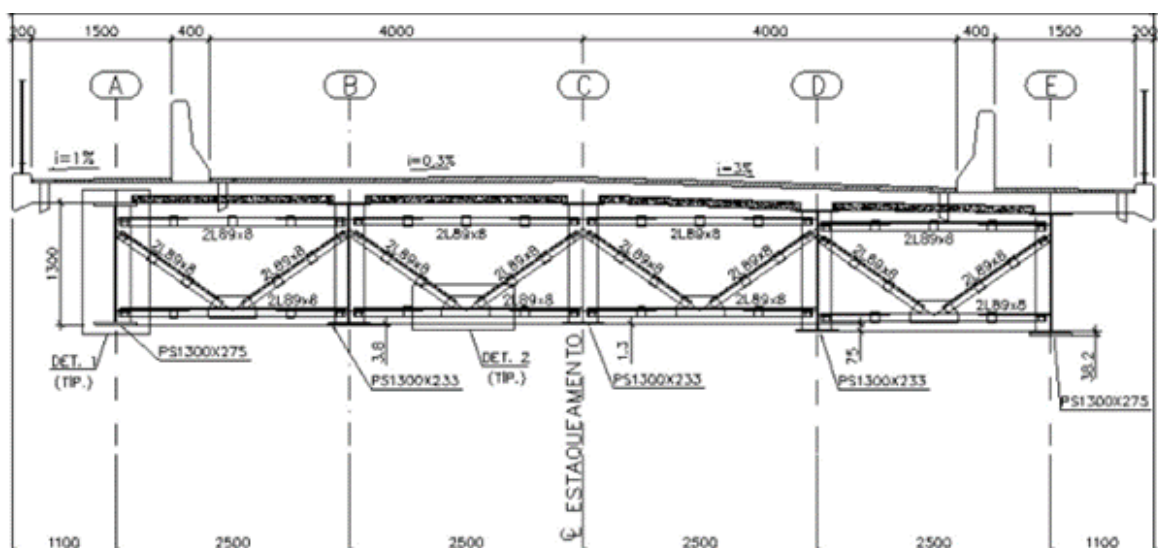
Seção transversal típica no trecho contínuo (vigas metálicas).
